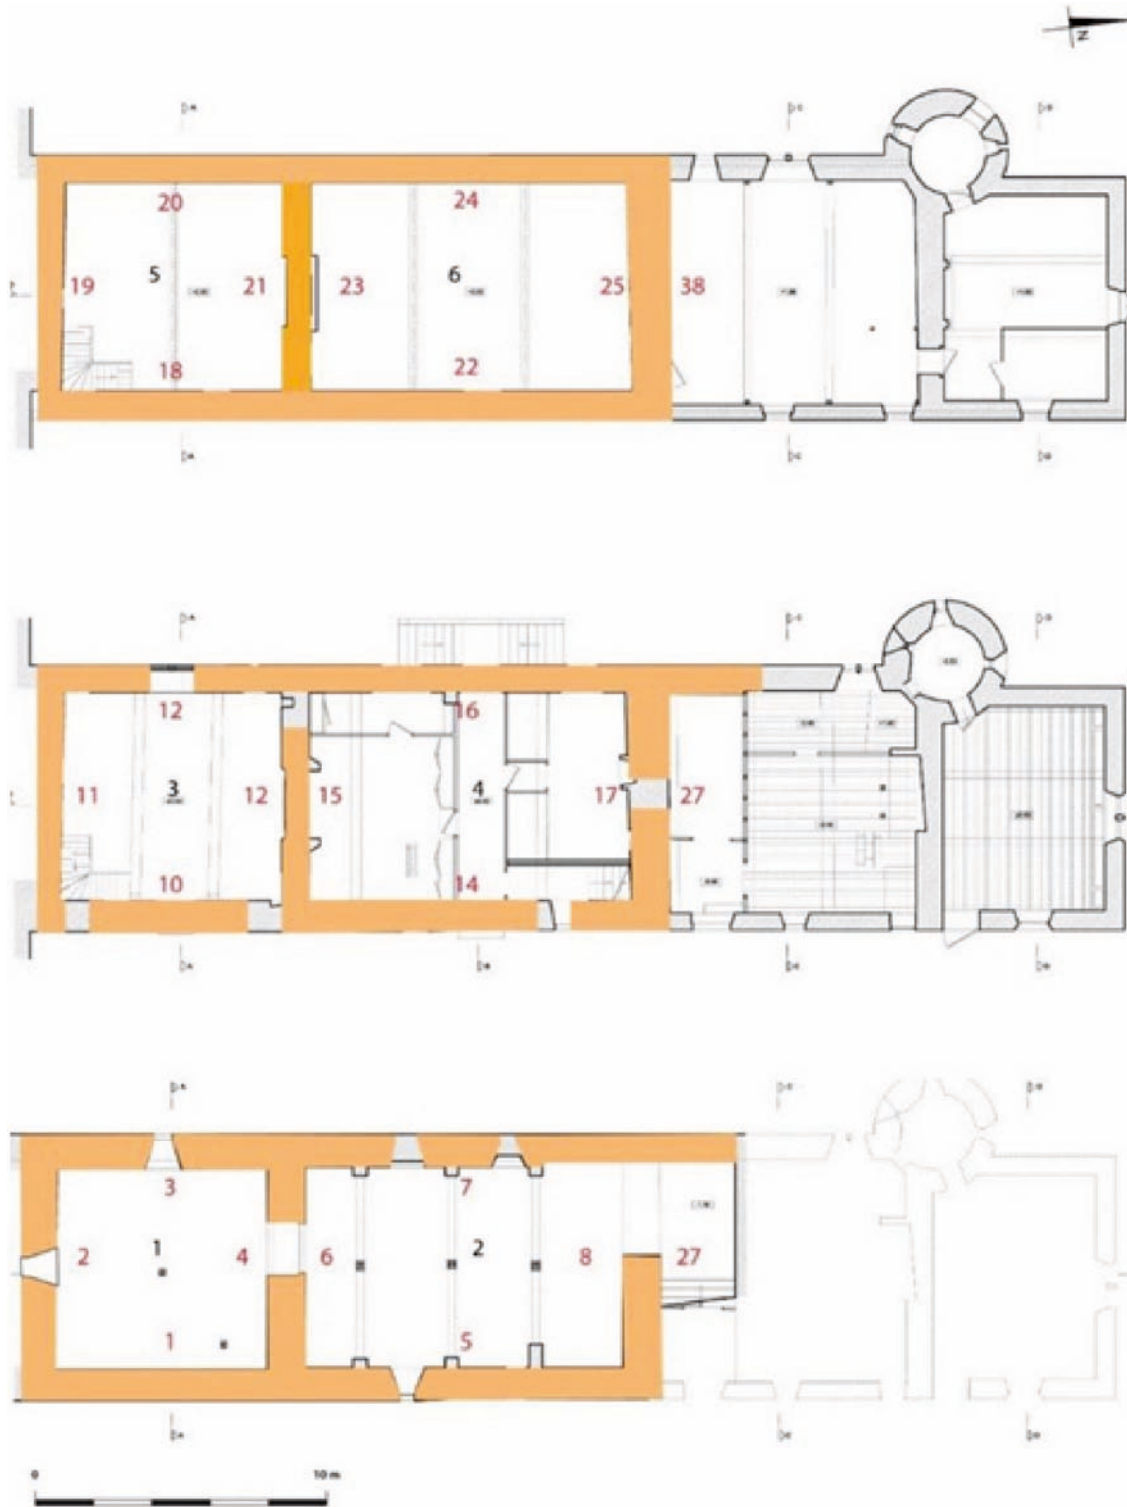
Plan des différents niveaux de l'état 1 (cave, rez-de-chaussée et étage) ; vue des éléments de l'état 1 conservé sur le mur pignon septentrional (fond de plan Daniel Juvenelle, architecte et associés).
